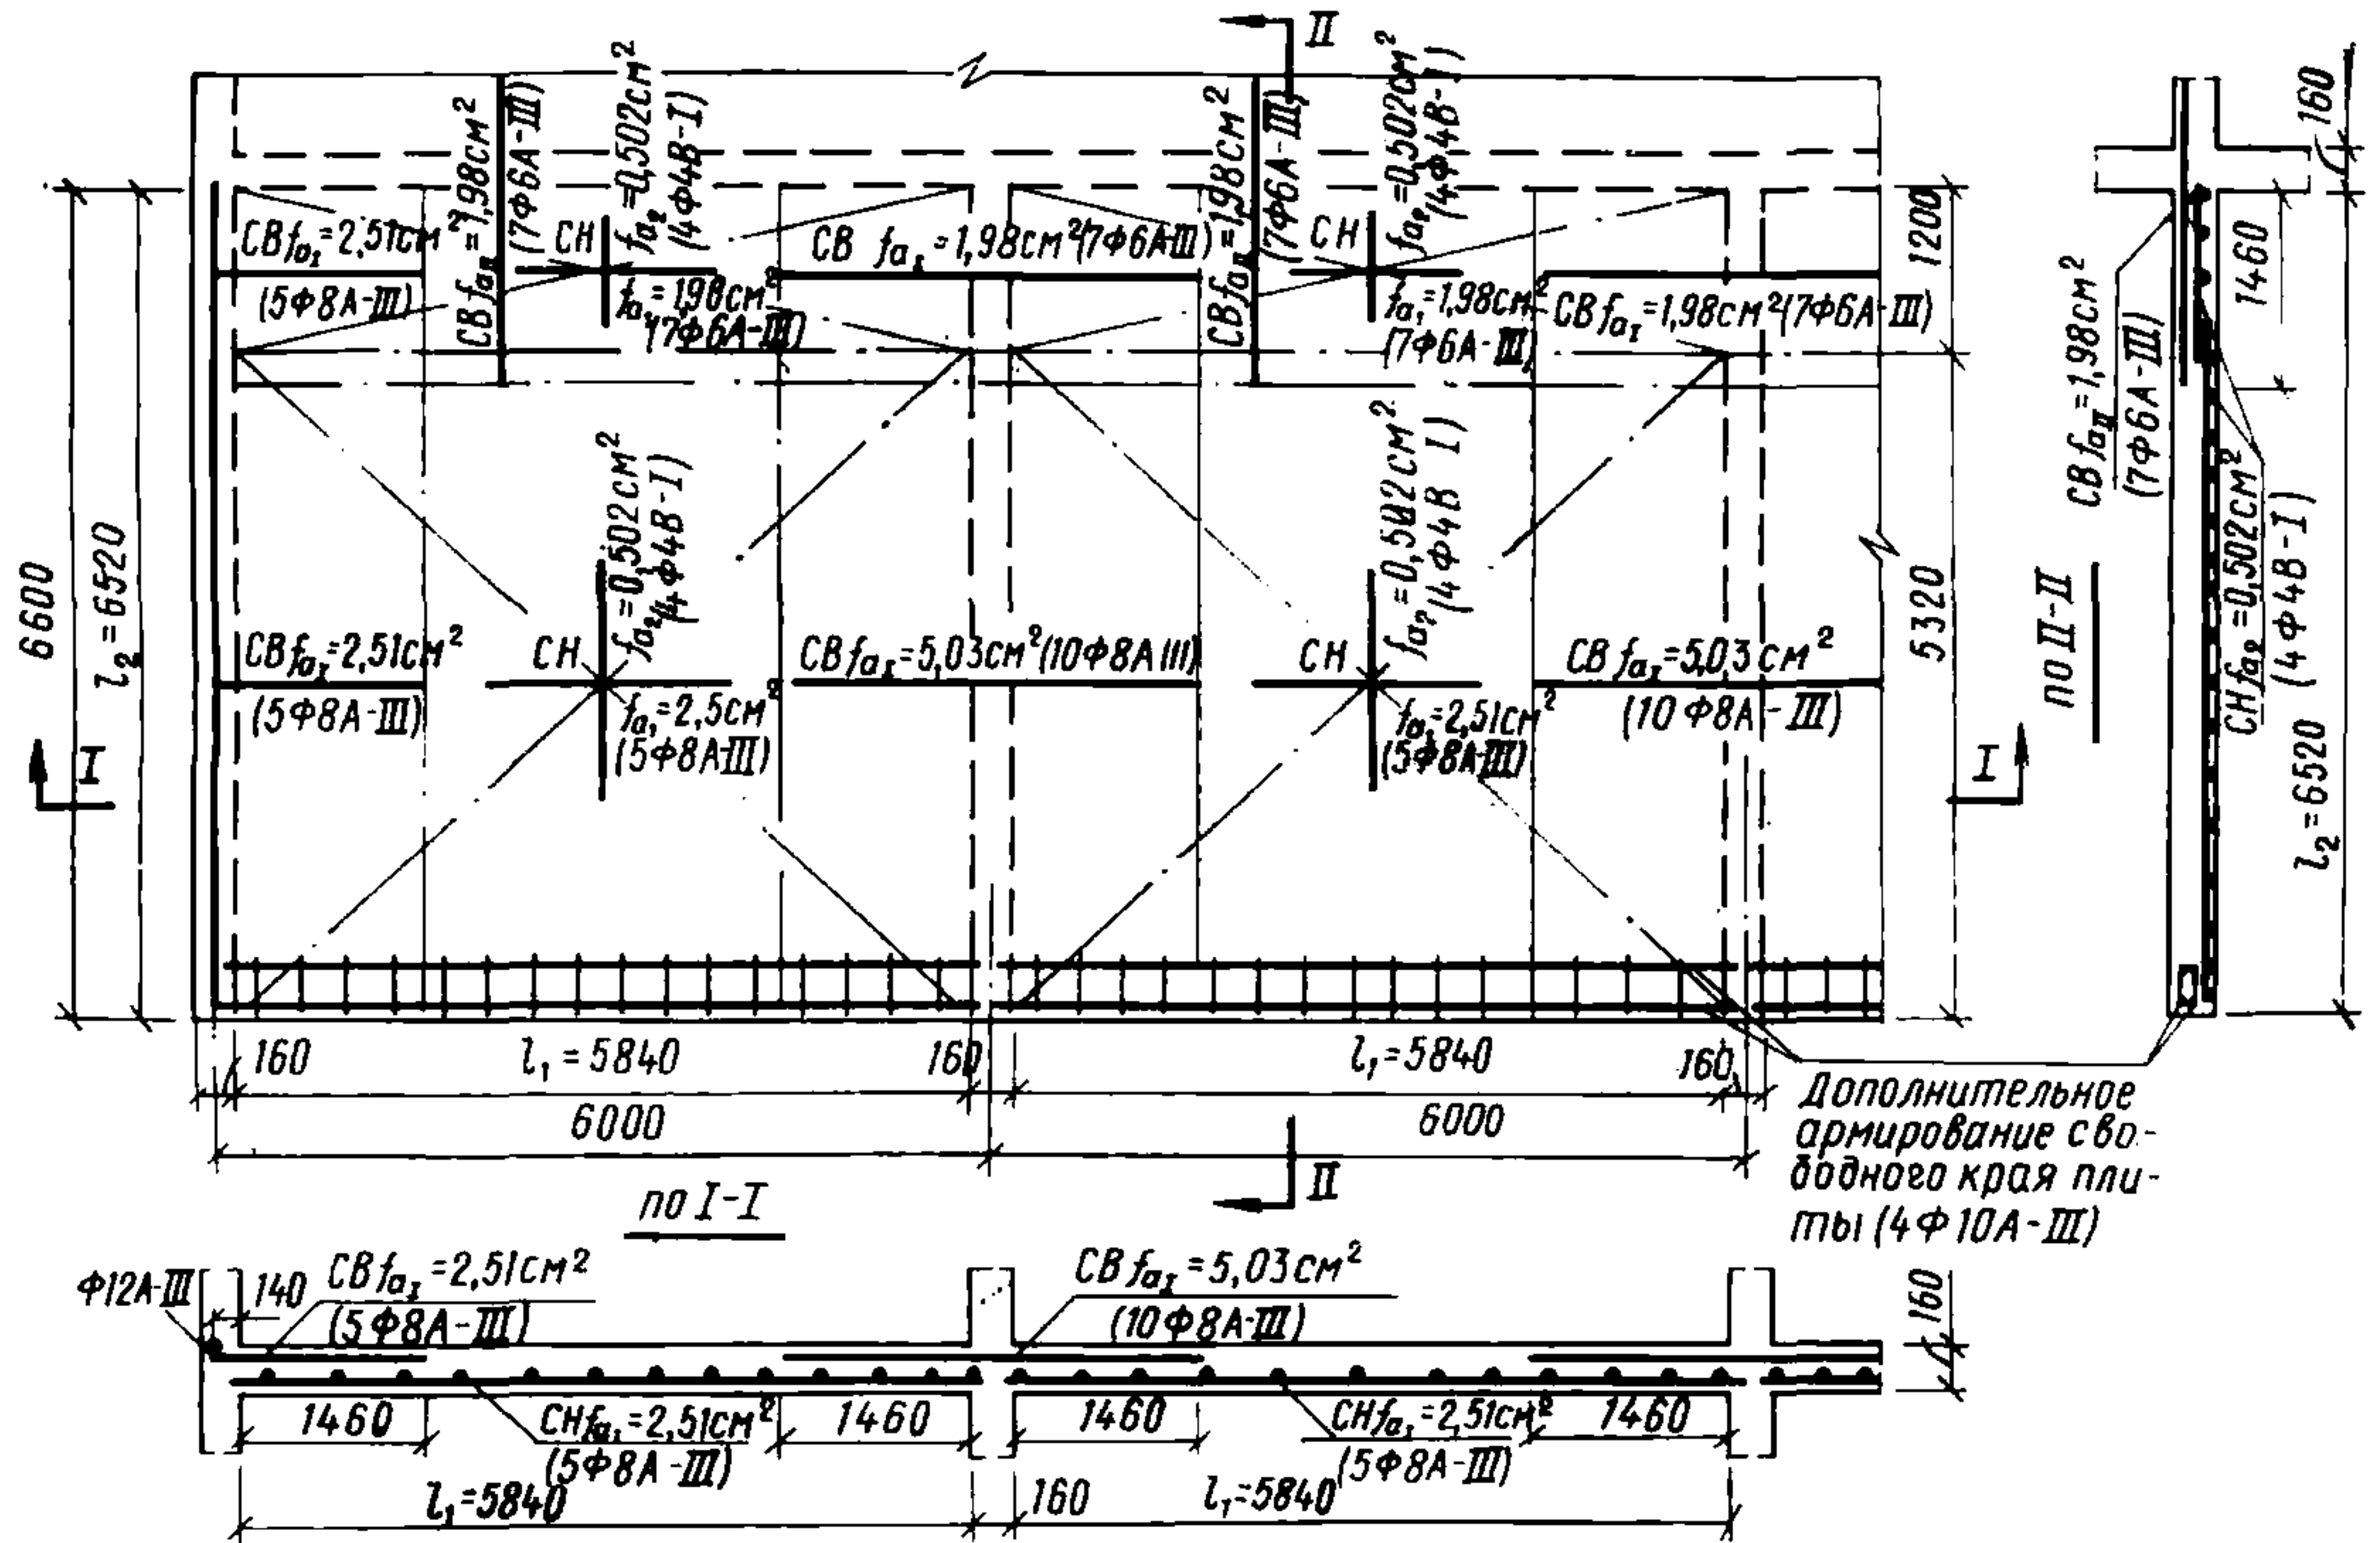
Схема армирования торцевой и рядовой ячеек плиты перекрытия
